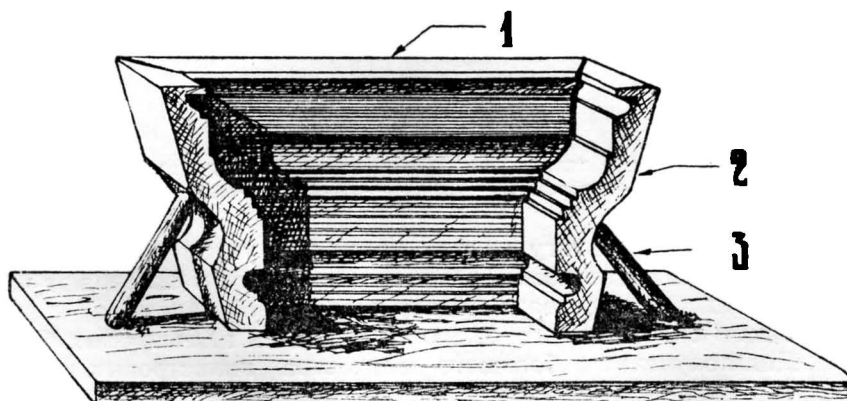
б. Разборная форма из тяг обратного профиля для отливки пилястровых капителей. 1 — лицевой кусок, 2 — боковые куски, 3 — подпорки
